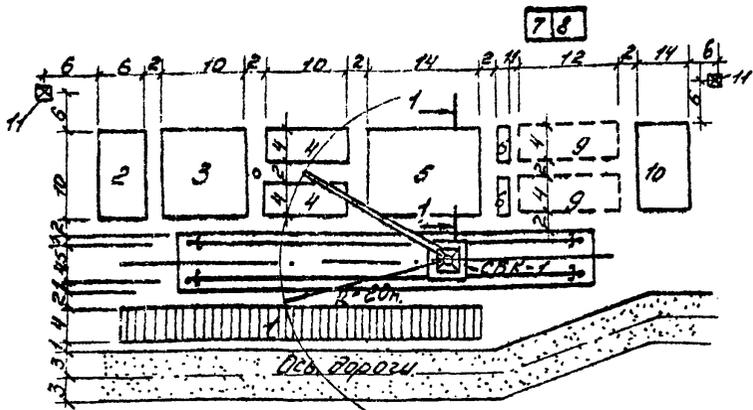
Схема сборно-комплектующей площадки для сборки арматурно-опалубочных блоков. 1 и 10 - склад блоков; 2 - склад щитов и панелей; 3 - станция ремонта и смазки панелей; 4 - склады панелей опалубки; 5 - стена сборки блоков; 6 - стеллажи; 7 - инструментальная кладовая; 8 - помещение для электросварочных аппаратов; 9 - склад арматуры; 11 - осветительная вышка.
